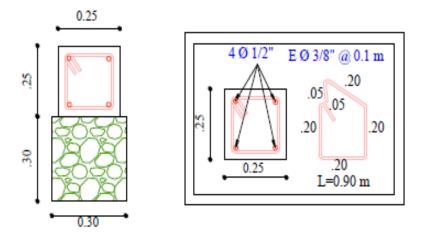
Detalle de Vigas de cimentación en concreto reforzado.
